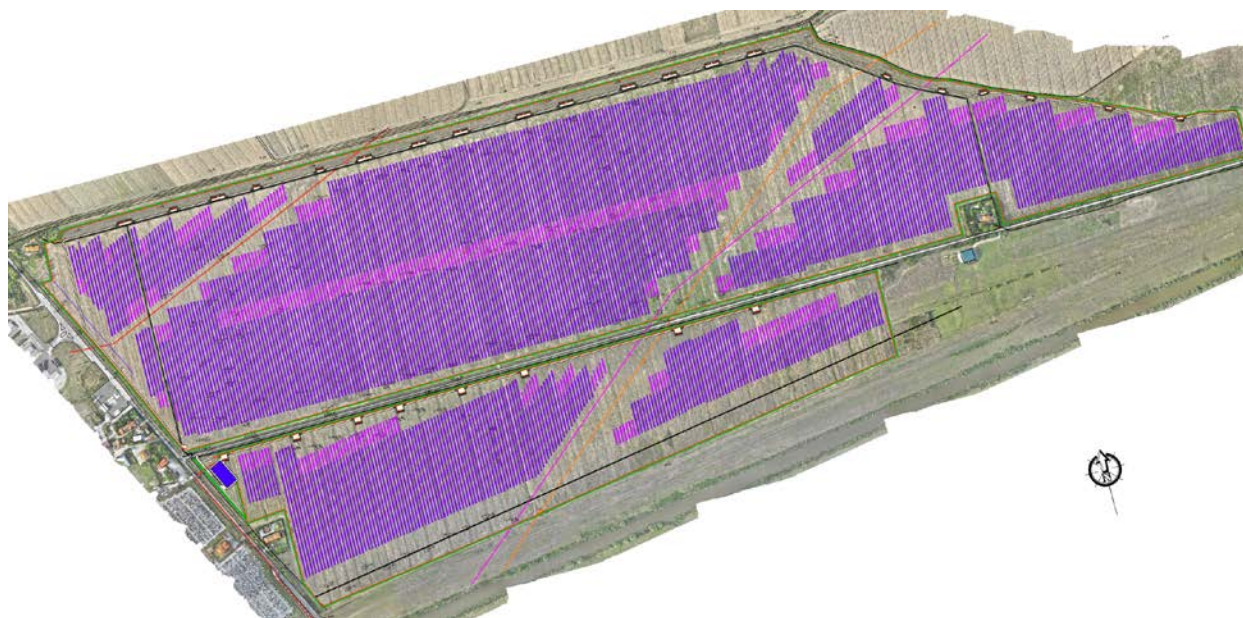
planimetria di progetto con indicazione dei pannelli e delle principali opere interessate dell'impianto
